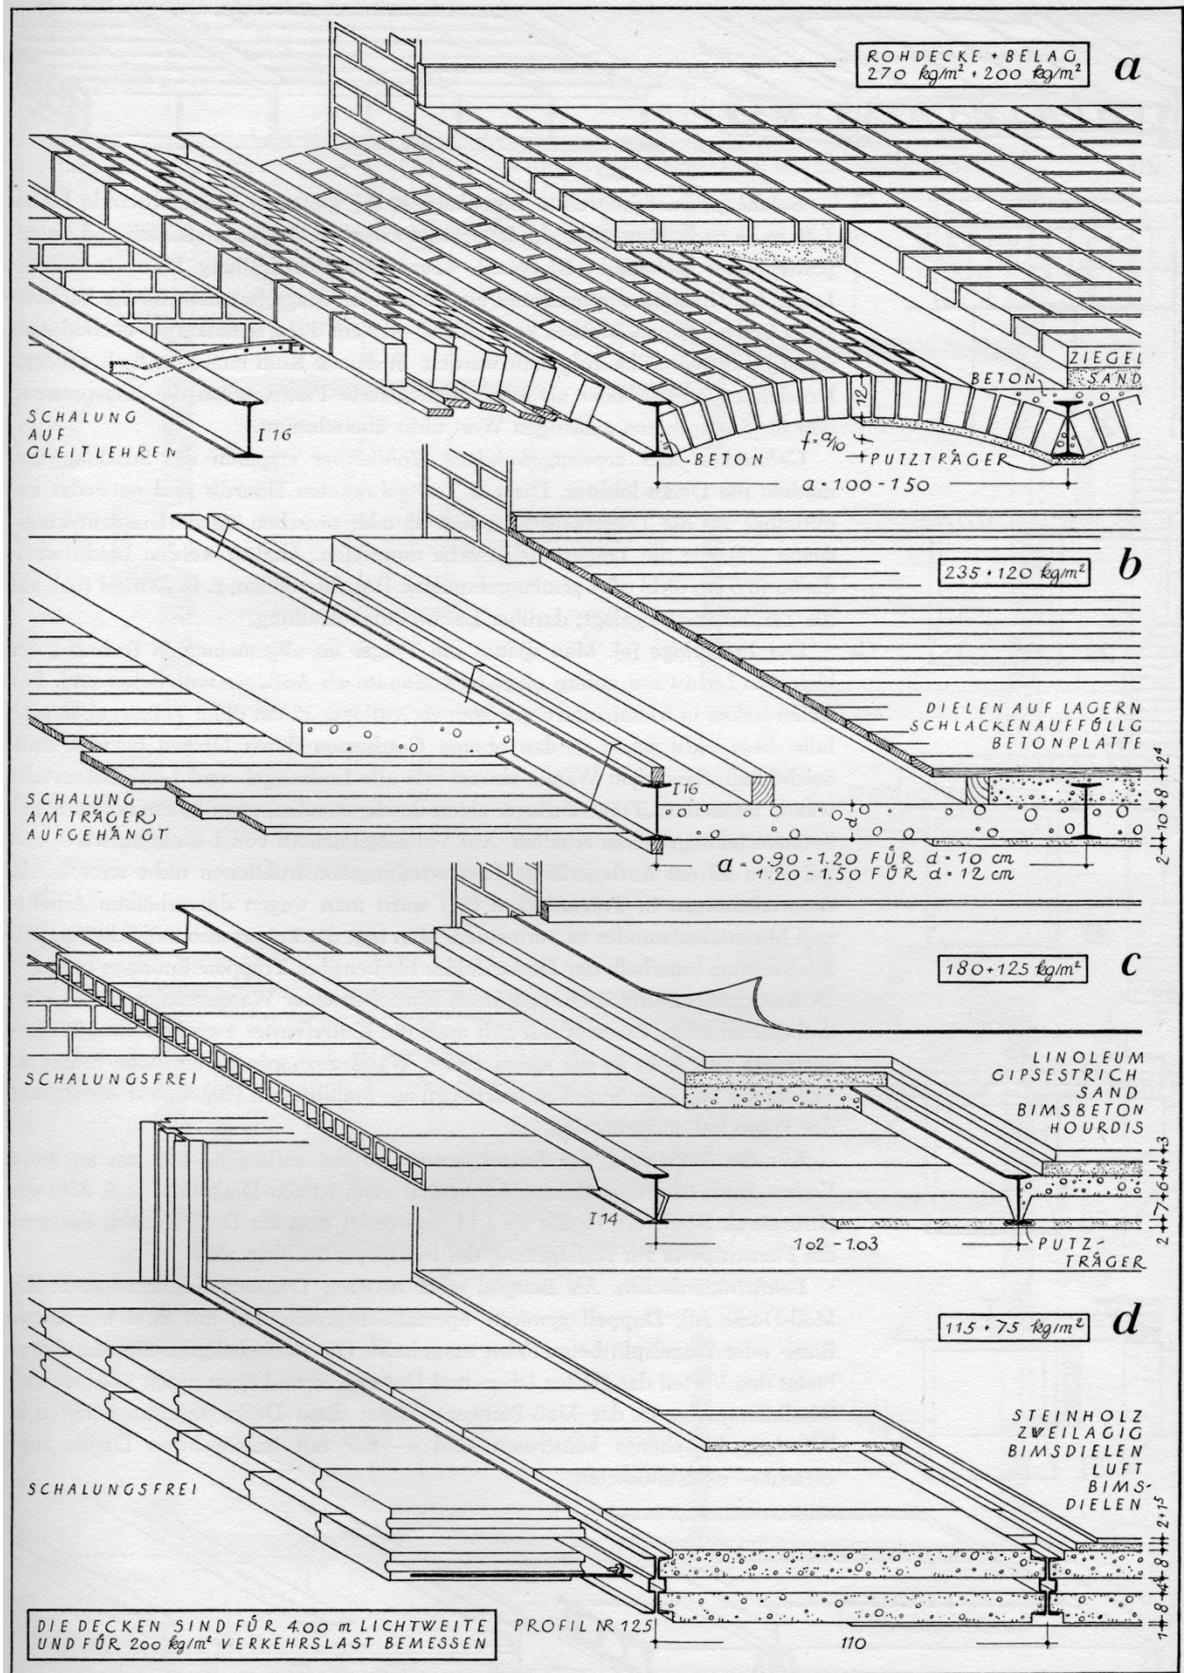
Stahlträgerdecken aus Franz Hart, Baukonstruktion für Architekten, 1950
